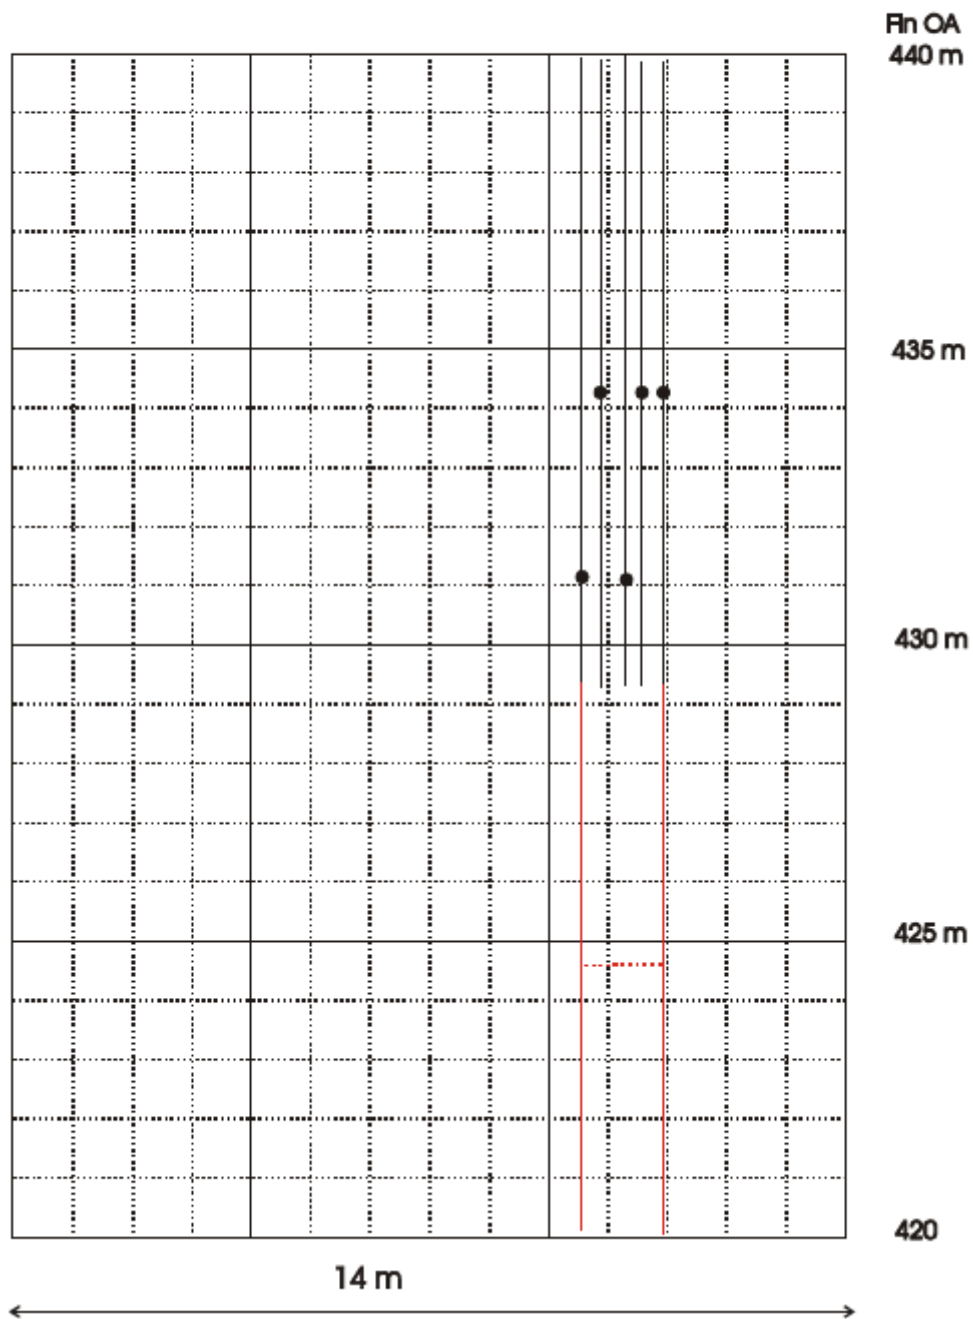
Planche de fissuration travée Sud Zone 1
